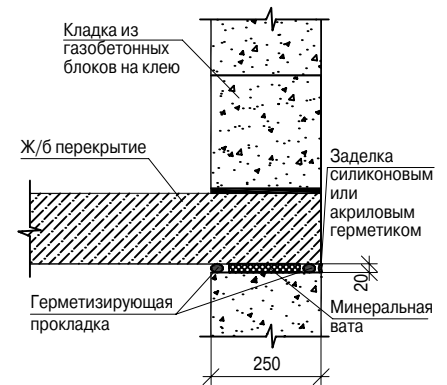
Схема устройства верхнего края кладки в месте ее примыкания к монолитному перекрытию
